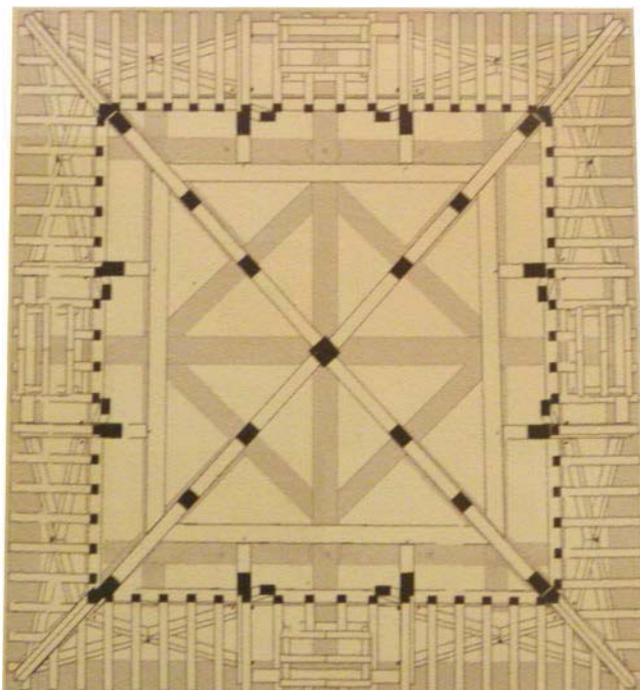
sección horizontal sobre el primer entramado de la armadura. Idem anterior
